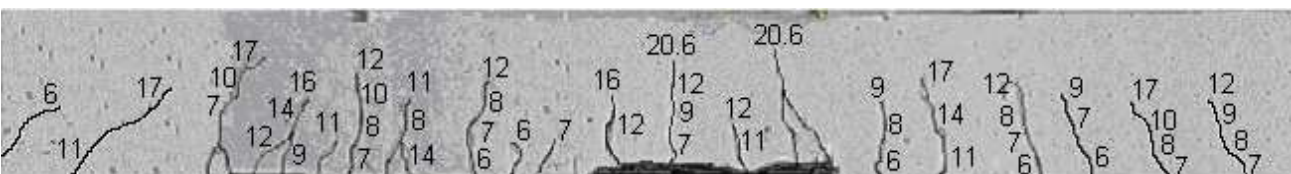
Detalhe do panorama de fissuração da viga 4
